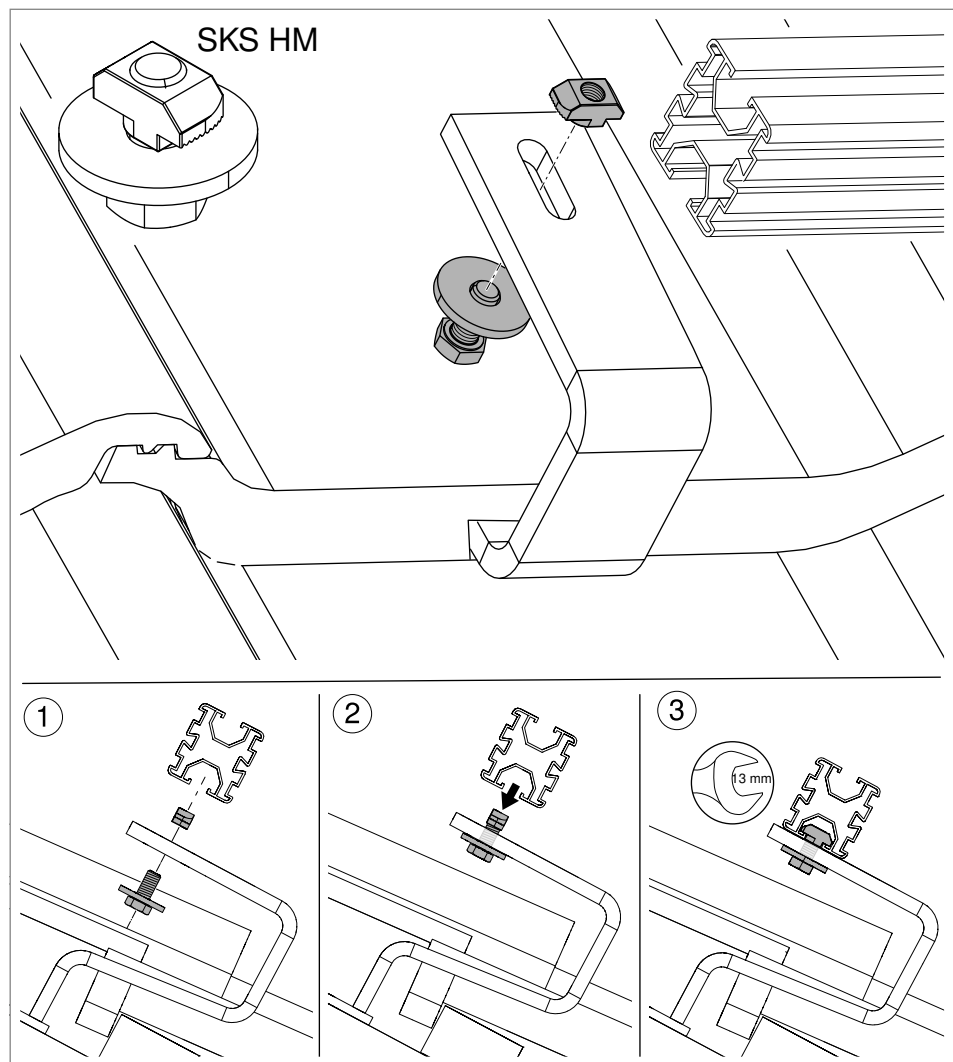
Trägerprofil an schweren Dachhaken montieren
